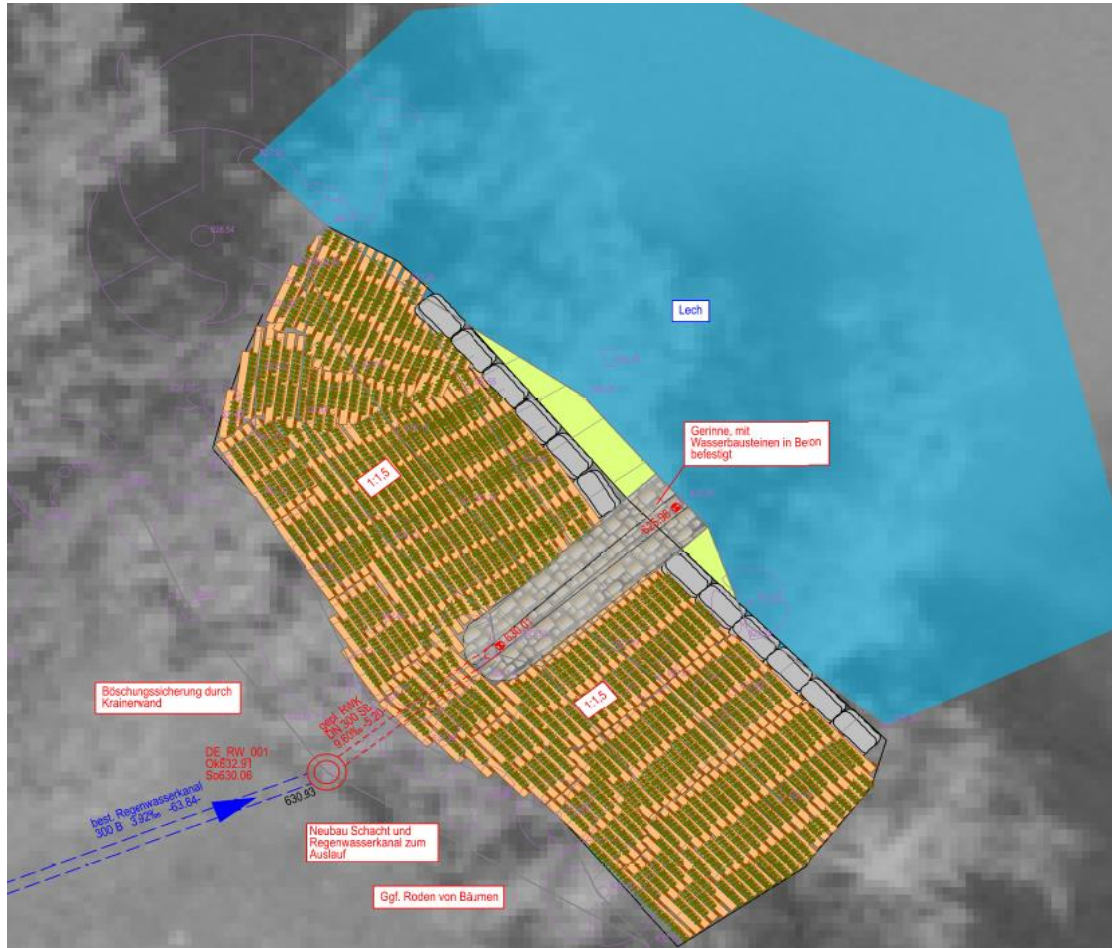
Ausschnitt aus Lageplan 118127-02-HW
